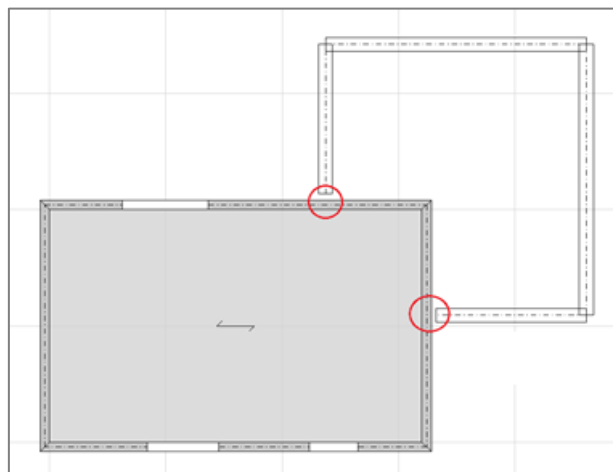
Corretta modellazione delle travi di fondazione a livelli sfalsati
